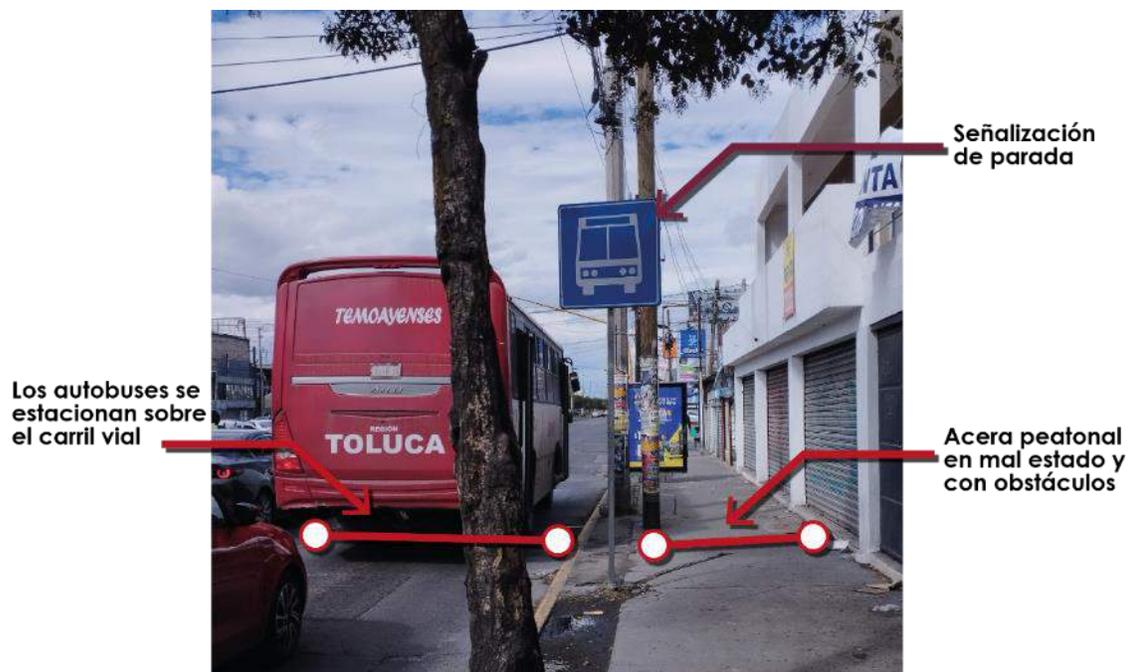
Infraestructura encontrada en paradas Tipo C. Fuente: elaboración propia.
